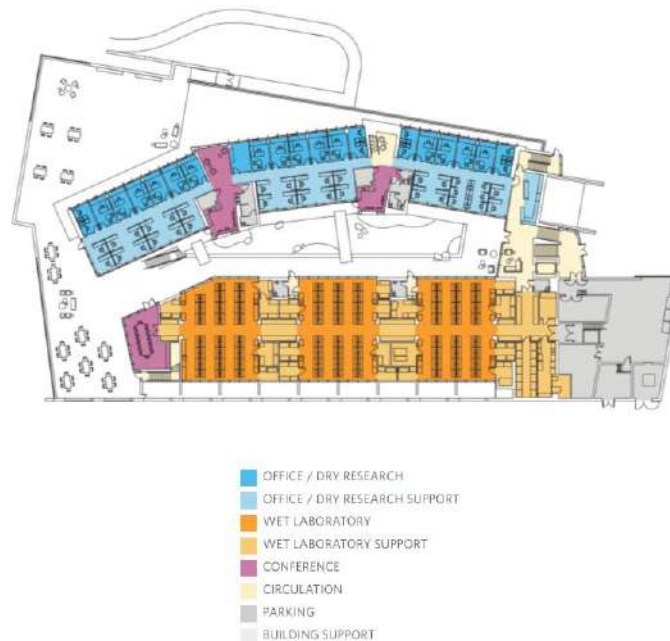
Master Plan J. Craig Venter Institute La Jolla
